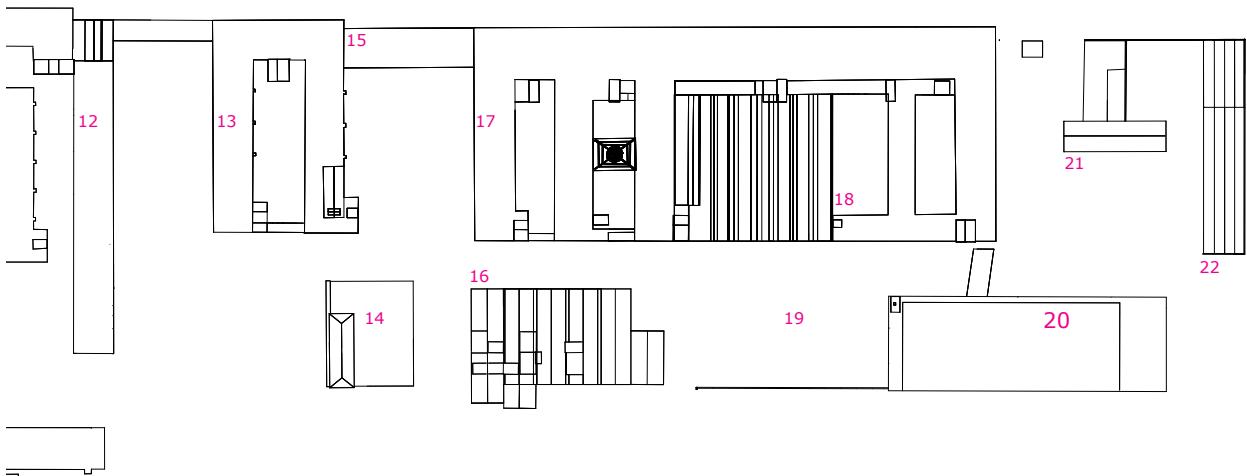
Grundrissplan der Bestandsgebäude
